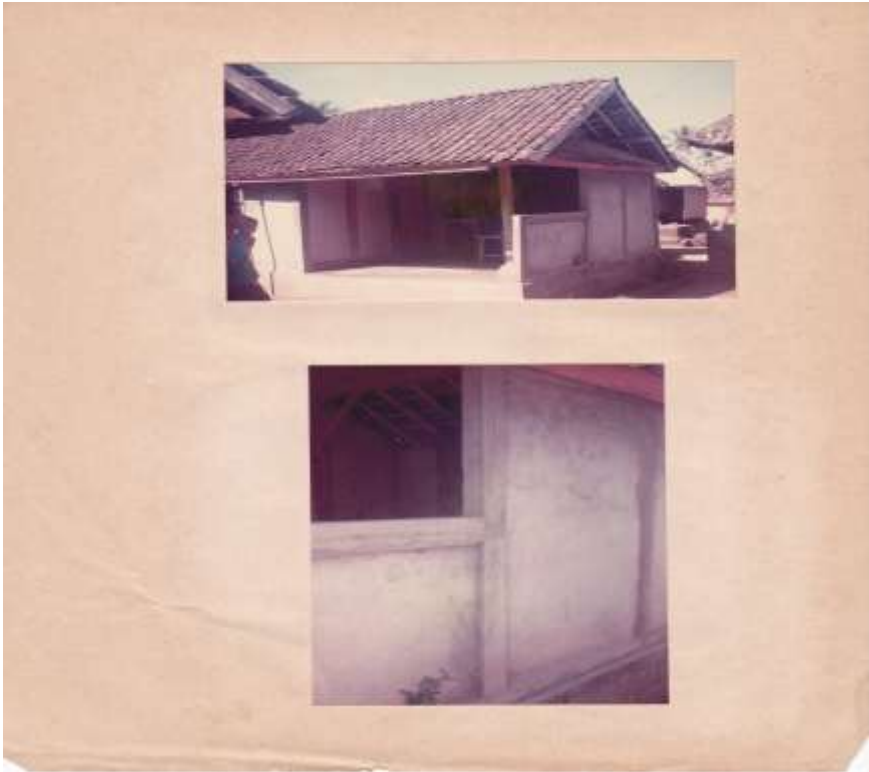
Finishing Tembok/Dinding Setebal 7 cm
